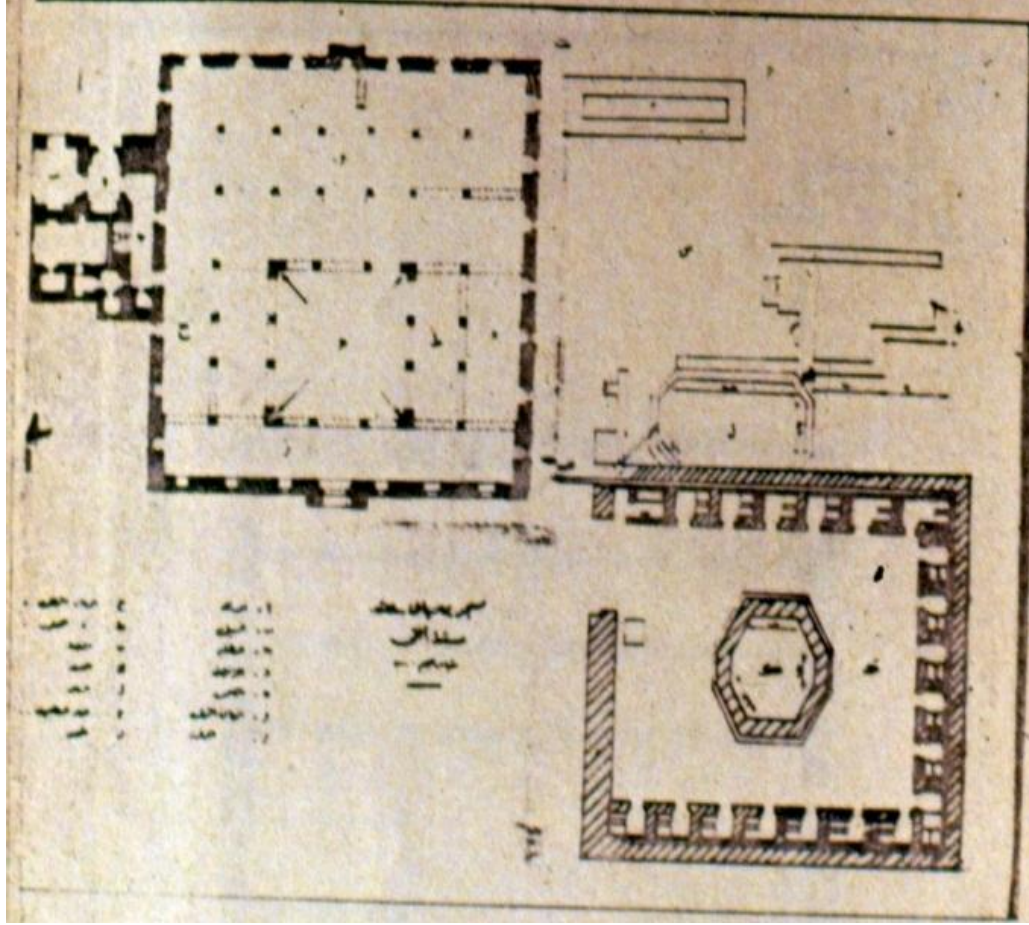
مسقط أفقي لمسجد الصالح ملاح عن: كرسويل.
